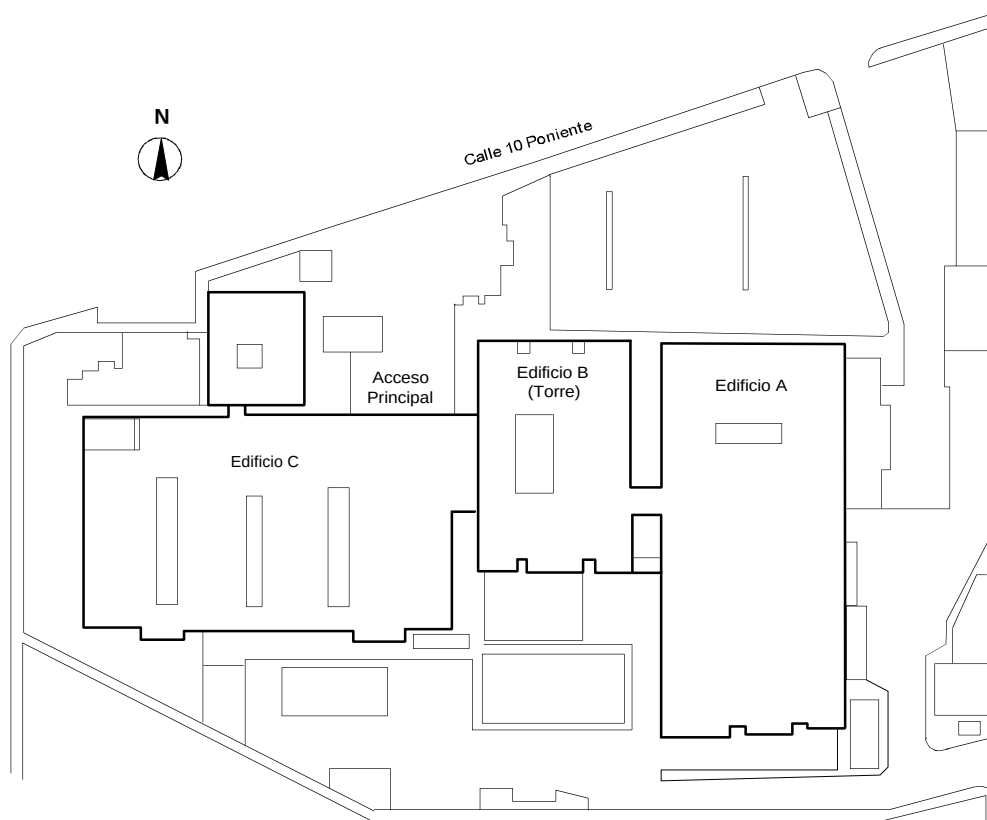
Planta de conjunto del Hospital San Alejandro
